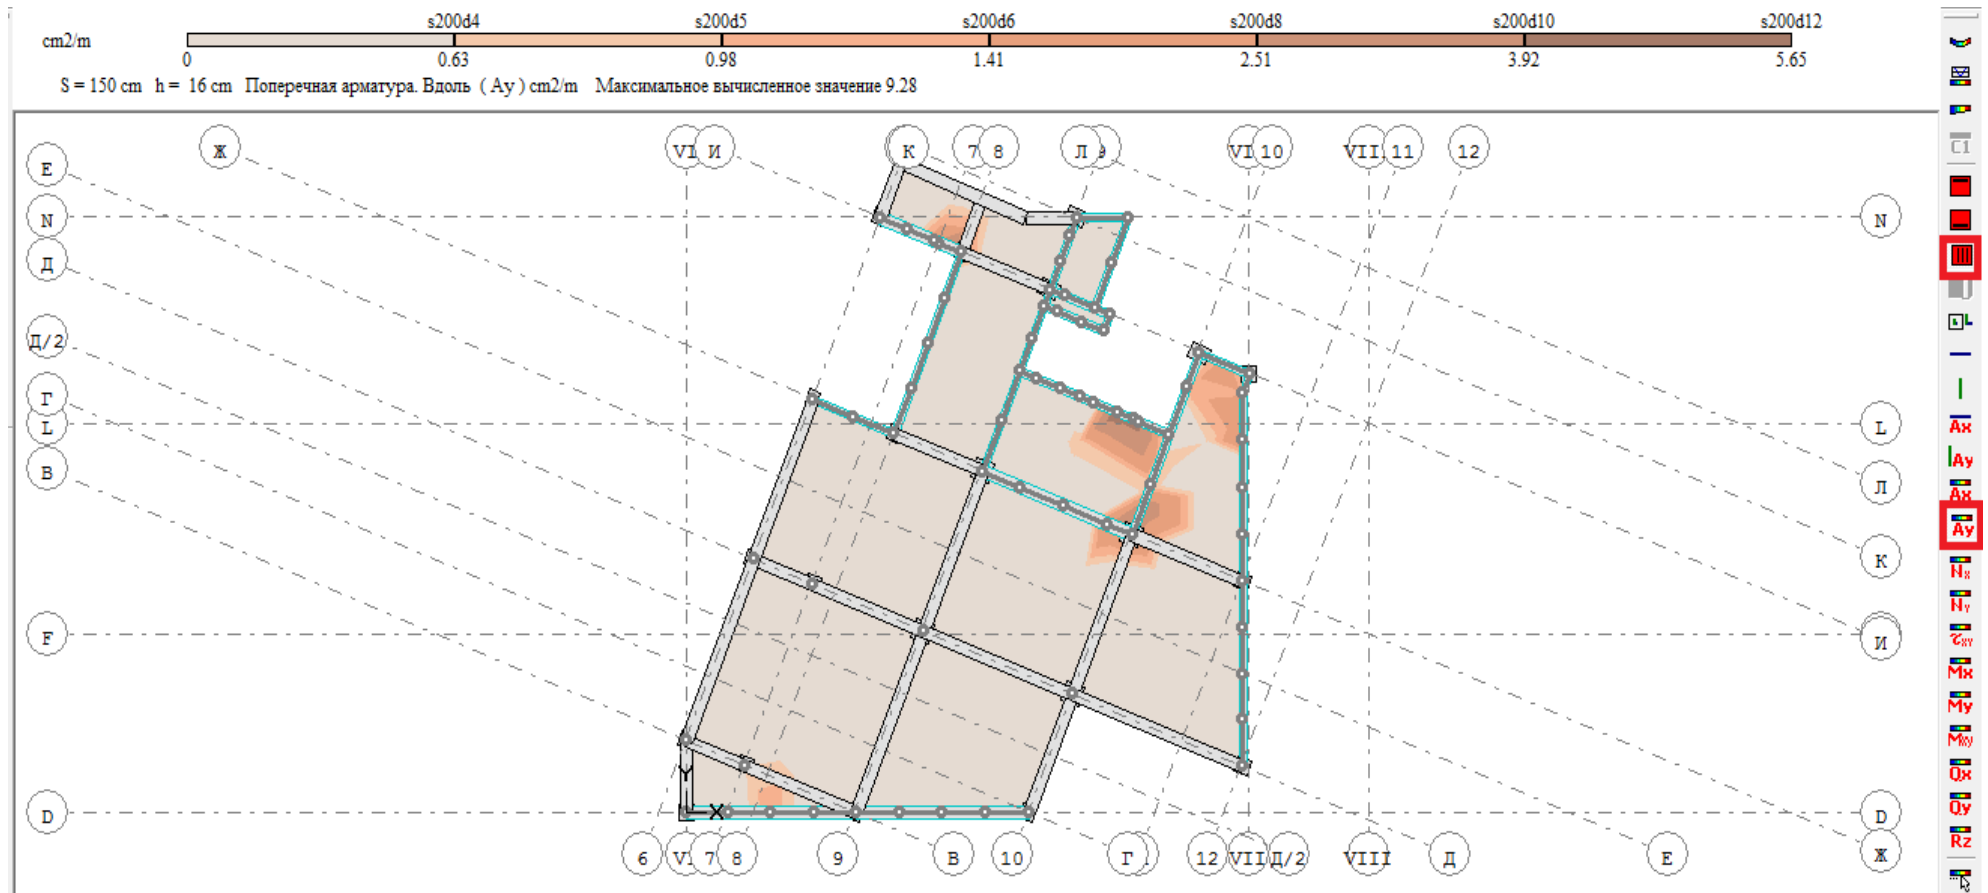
Плита перекрытия на первом поверсі. Розподіл робочої поперечної арматури по нижній грані плити у напрямку вісі ОУ
